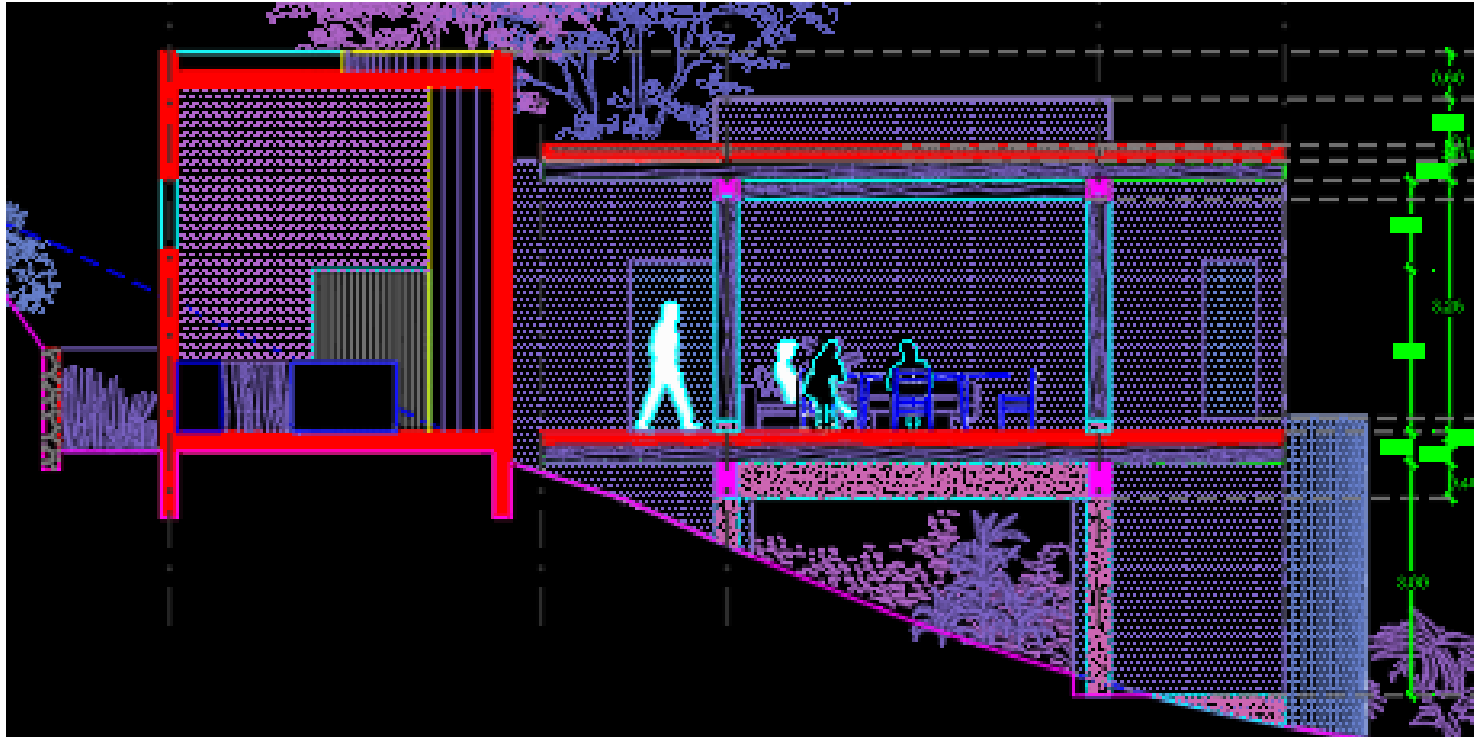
VISTA EN CORTE TRANSVERSAL DE PLANTA SÓTANO, PLANTA BAJA Y PLANTA TRABES TECHO, A LA ALTURA DEL ANEXO
